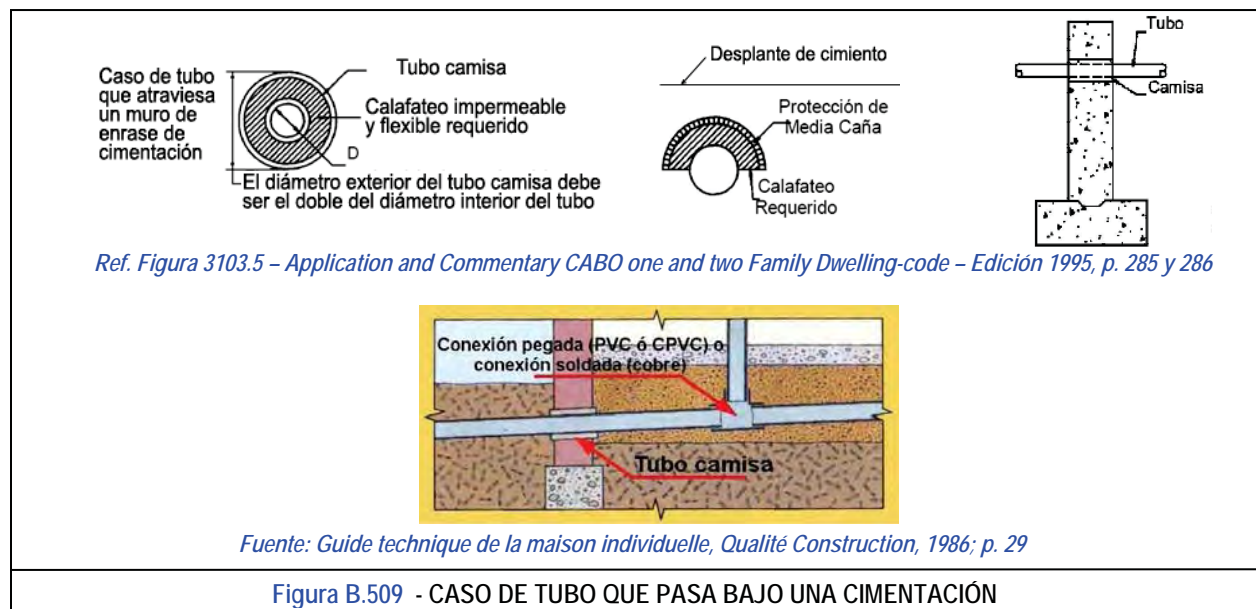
CASO DE TUBO QUE PASA BAJO UNA CIMENTACIÓN
